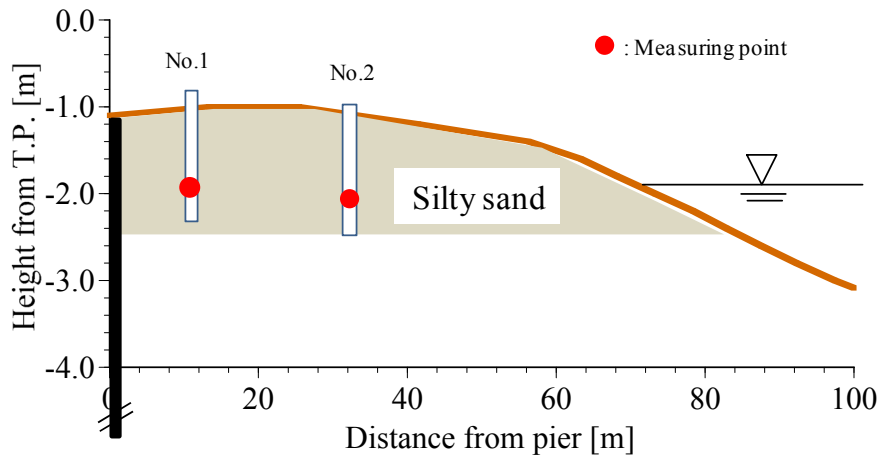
St.6 の横断面図と測定位置（機器は井戸内に設置されている）
